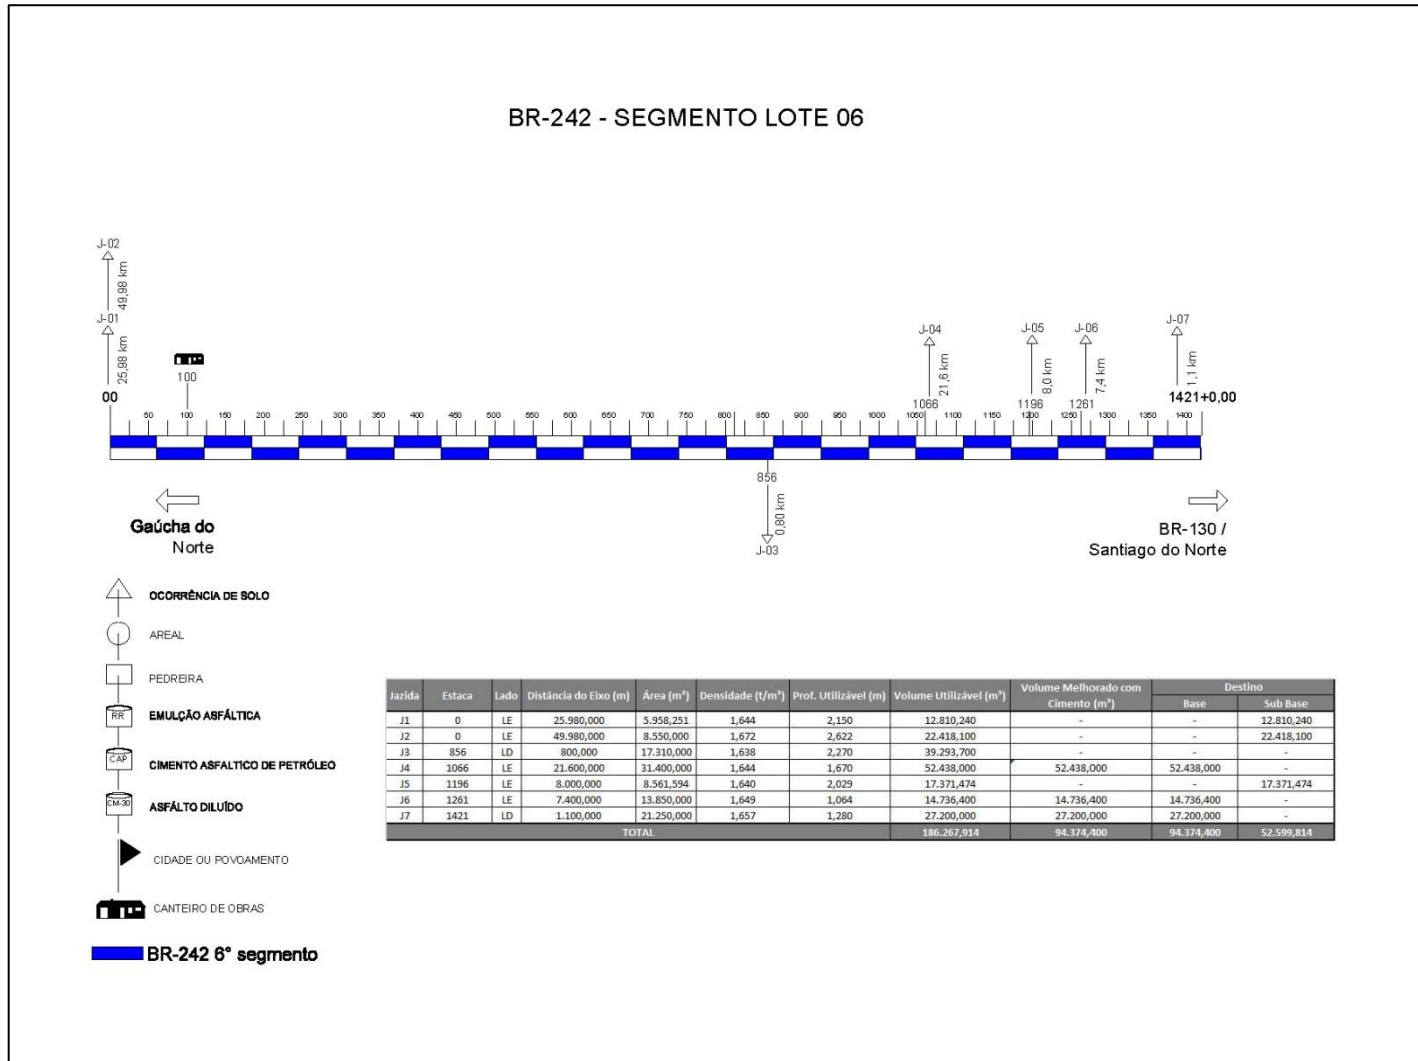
Diagrama da localização das fontes de materiais para a pavimentação e as instalações industriais (Segmento A – lote 06).
